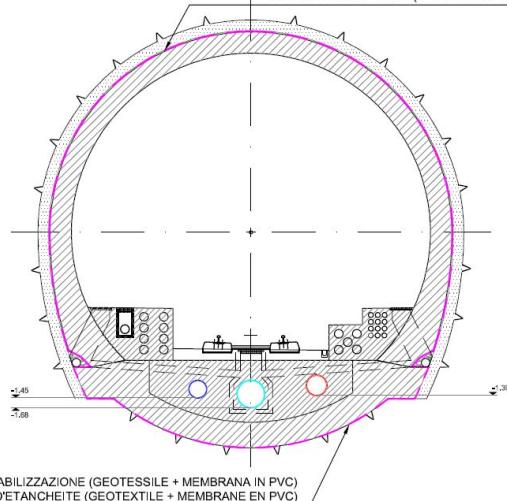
Impermeabilizzazione di tipo 2/2a per scavo tradizionale
